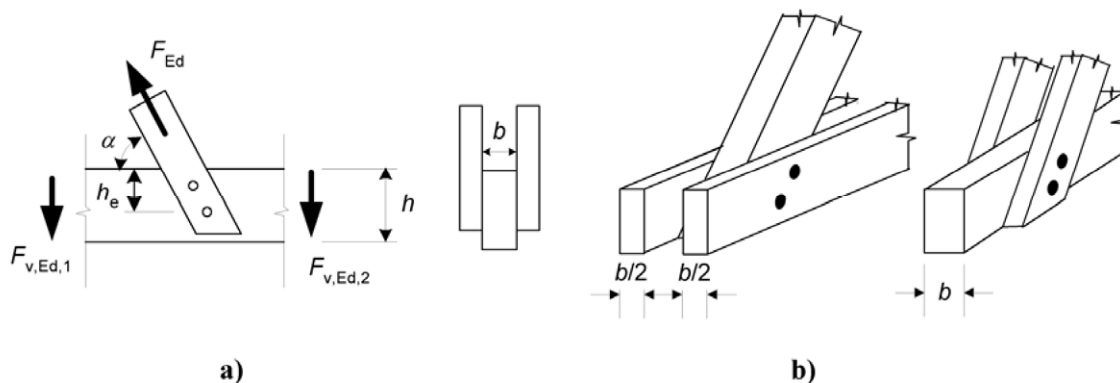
Fuerza inclinada transmitida en una unión
